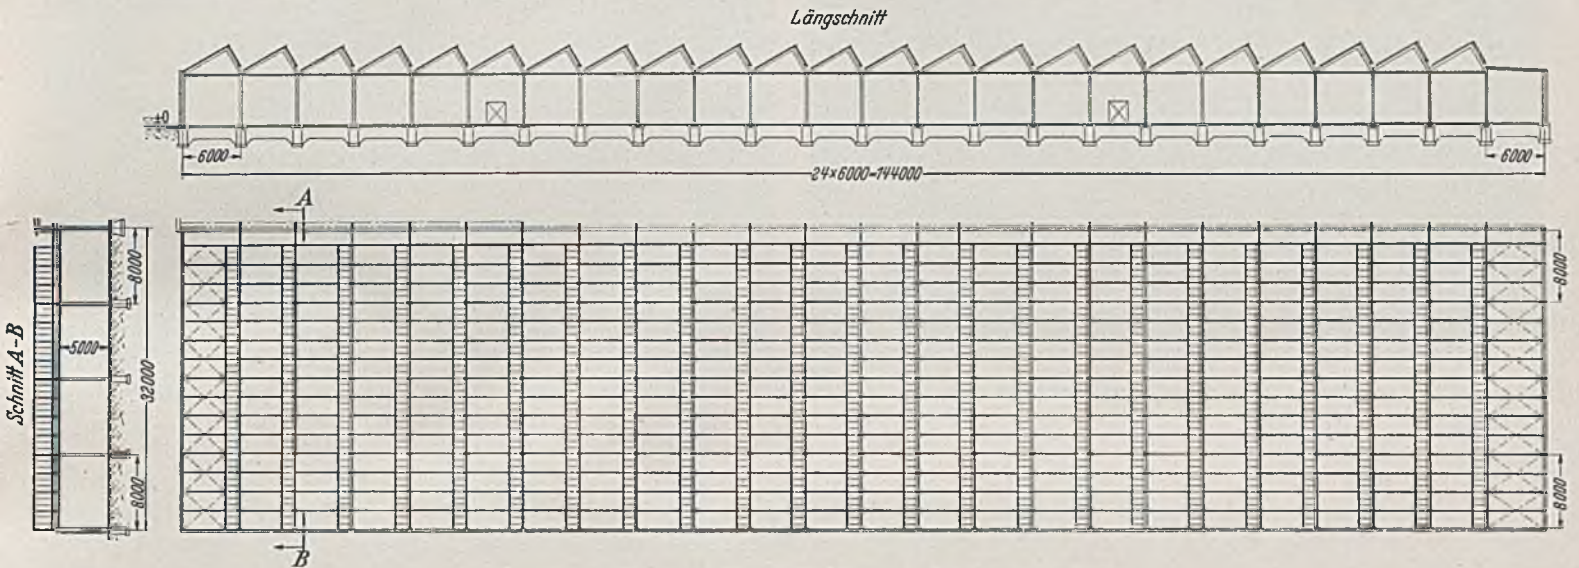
Bau 4: Grundriß, Quer- und Längsschnitt.
